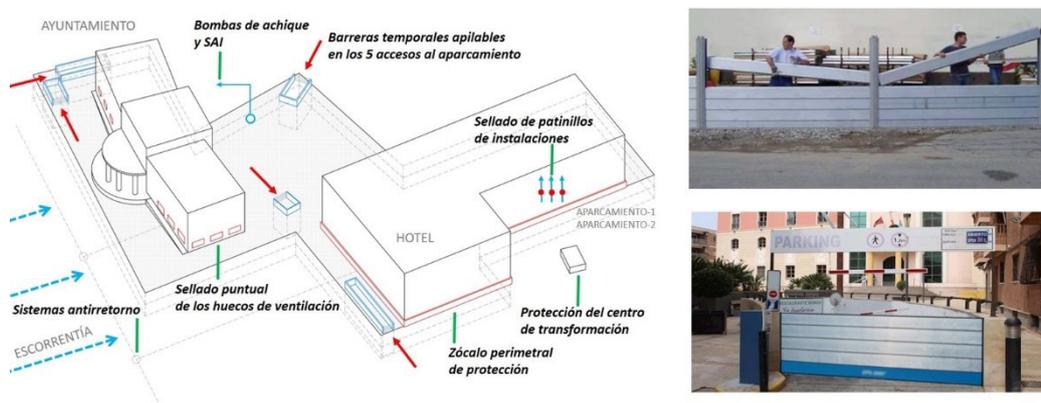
Caso piloto en Los Alcázares: esquema resumen de la propuesta. Detalle: barreras apilables (Fuente: CAG Canalizaciones) y ejemplo de aplicación en el edificio.
